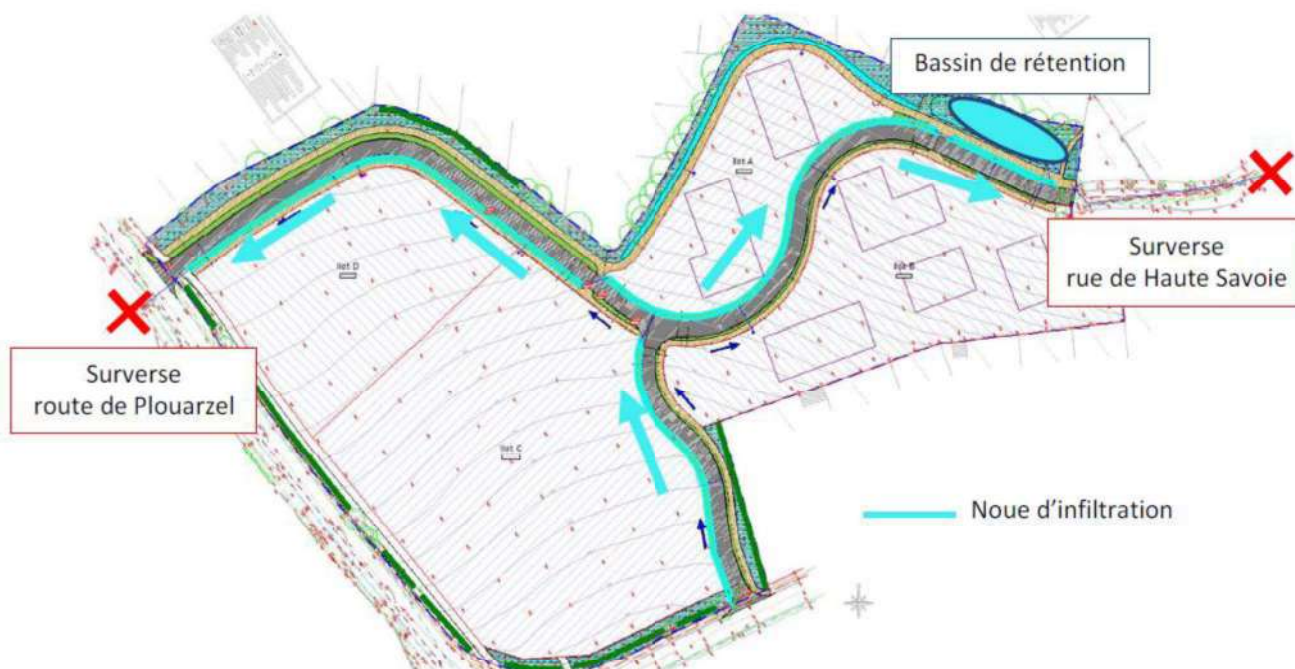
Plan de principe général de gestion des eaux pluviales (Source : SERVICAD)
